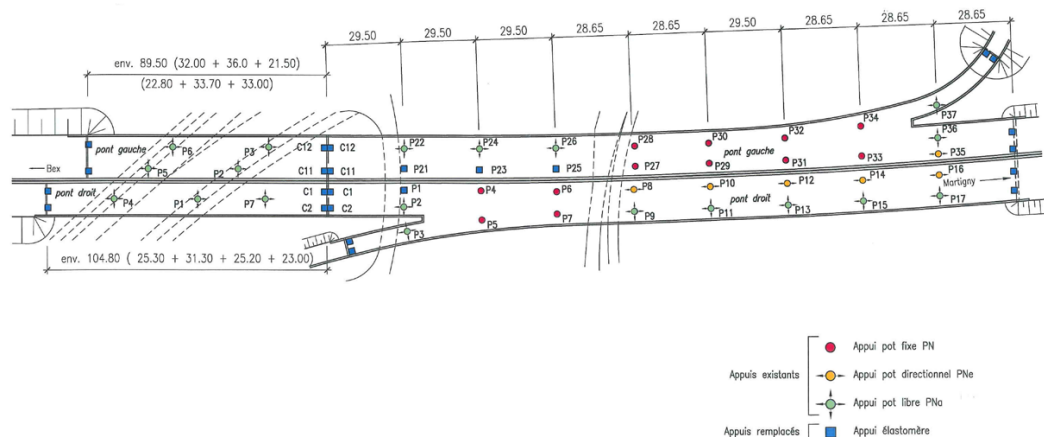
Grundriss der Zwillingsbrücken Bois-Homogène mit Lagerschema. Die neu eingebauten Gummilager sind blau eingezeichnet. Bestehende allseitig feste Lager sind rot, einseitig verschiebbliche Lager gelb und allseitig verschiebbliche Lager grün eingezeichnet.
